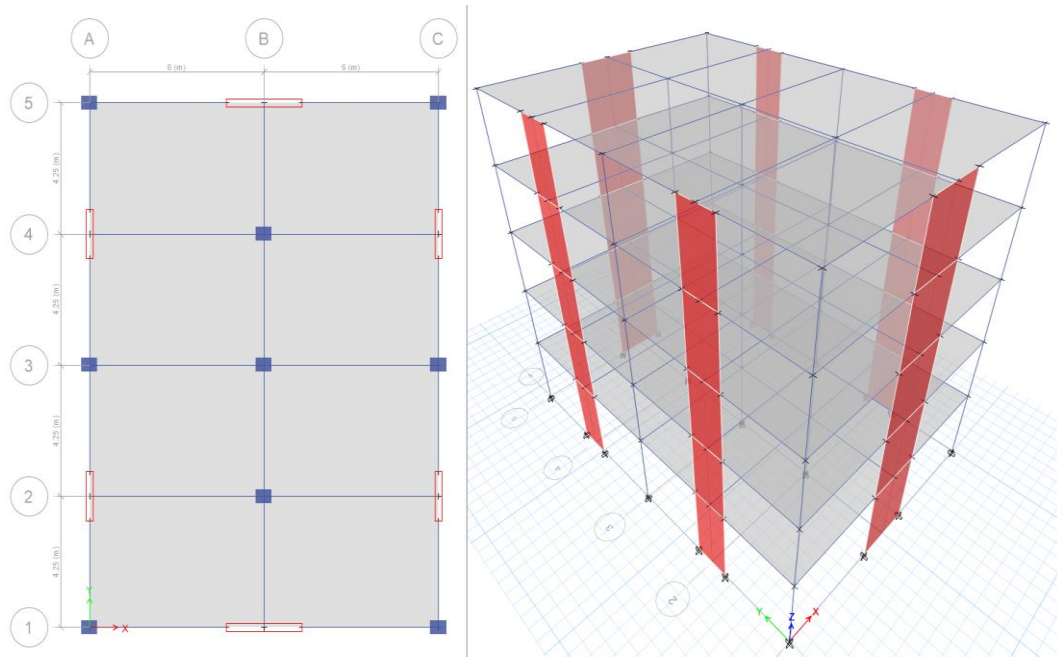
Visualización grafica en planta y 3D del sistema muros estructurales
